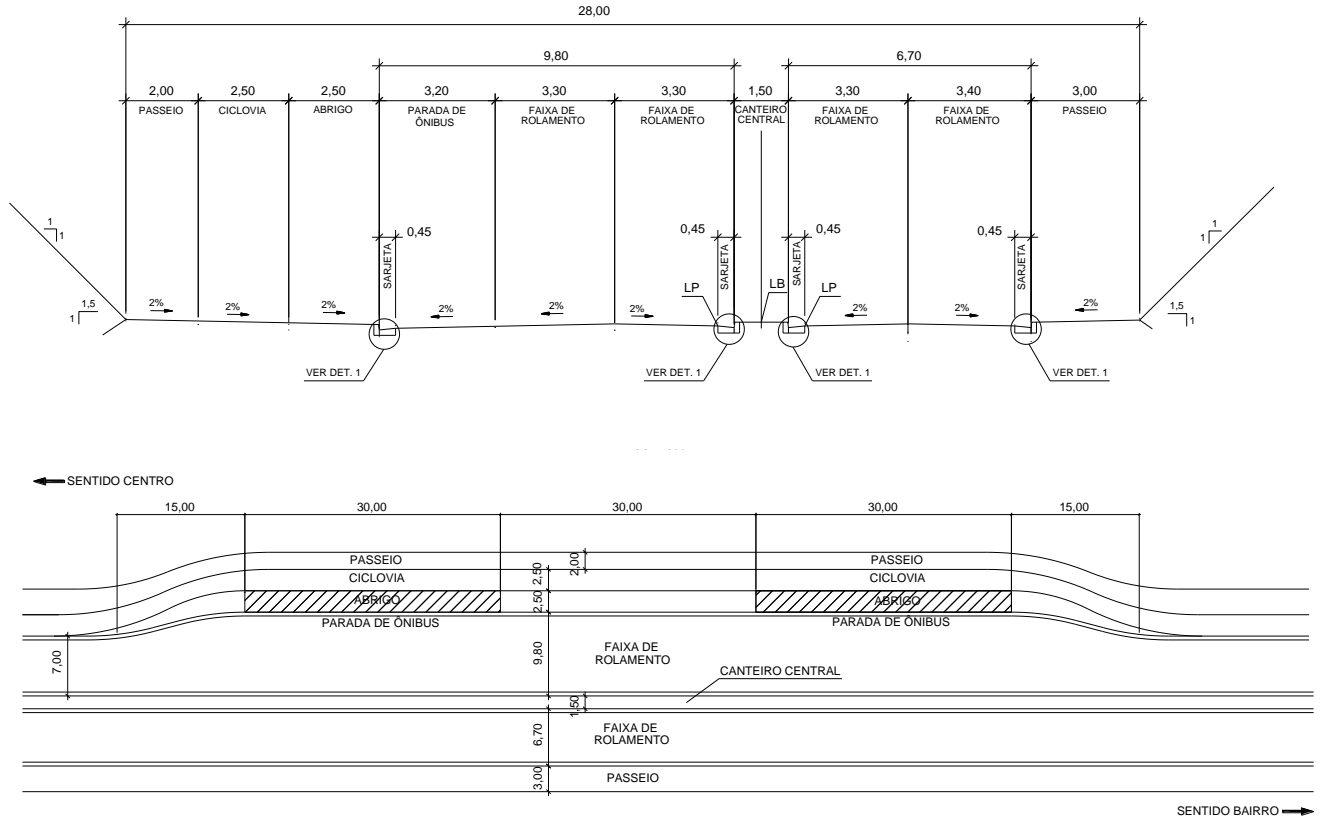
4 - Vista em corte e planta das baias ônibus e ciclovias do lado esquerdo.
